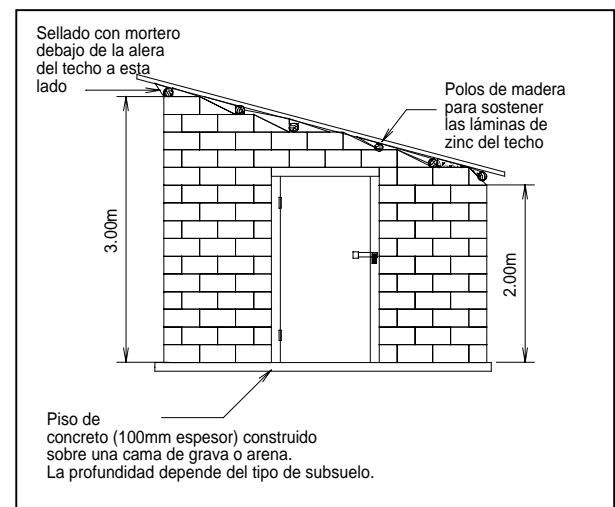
Técnicas recomendadas para la construcción de la casa de máquinas
